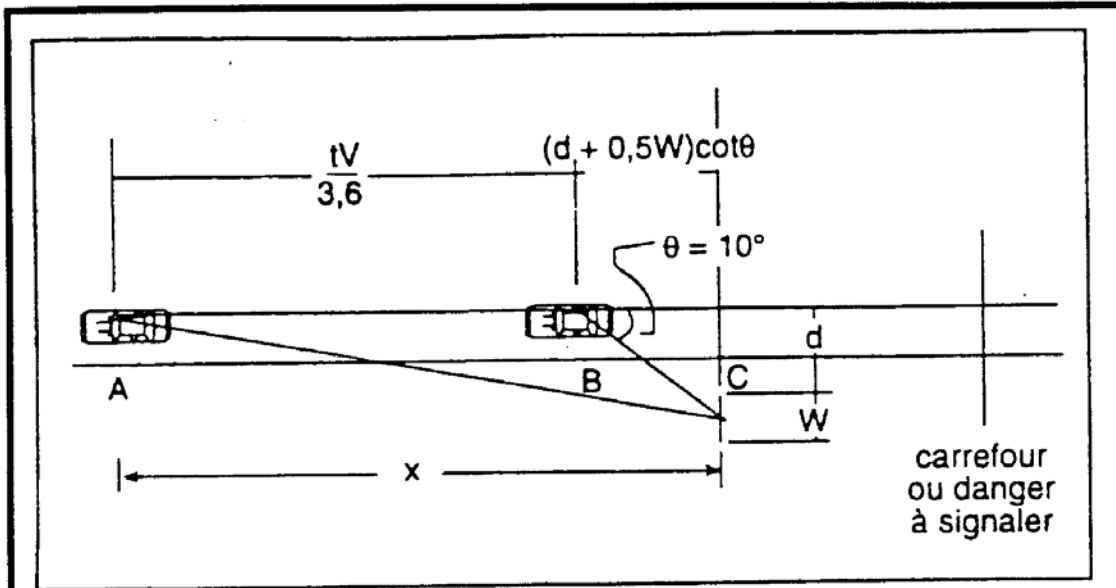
Lecture d'un panneau installé aux abords de la chaussée.
